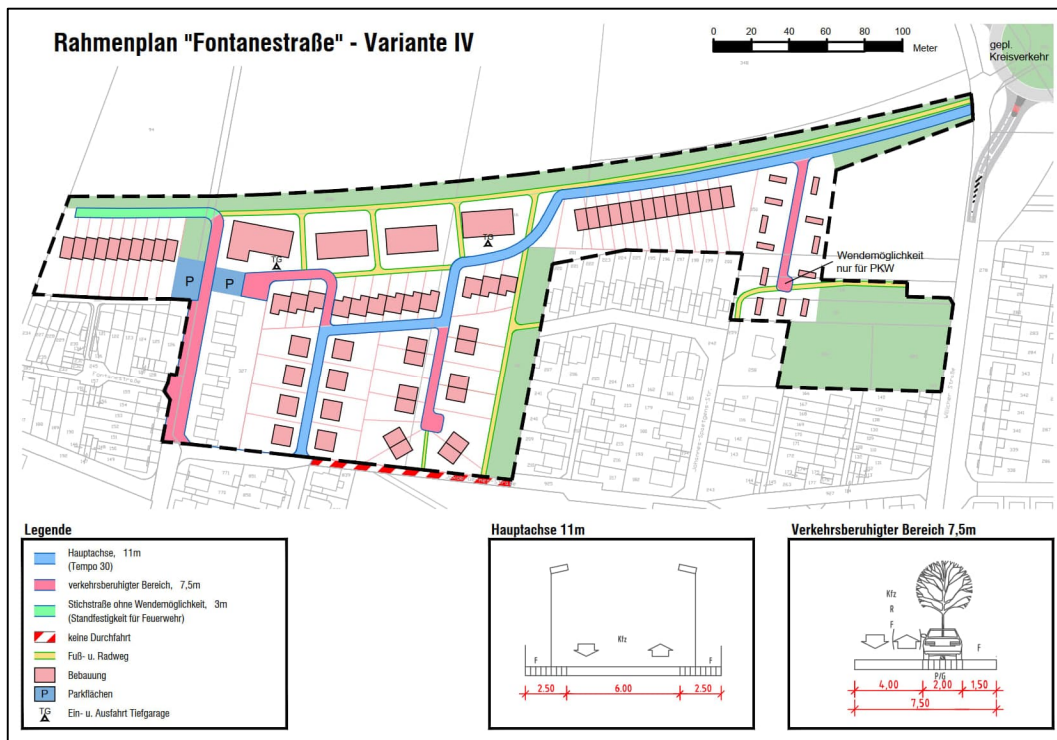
Rahmenplan „Fontanestraße“ – Variante IV [8]
